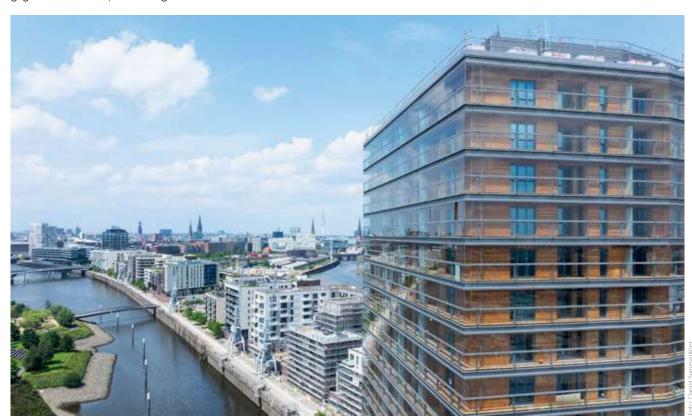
Roots Hamburg, das höchste Holzhybridgebäude Deutschlands
